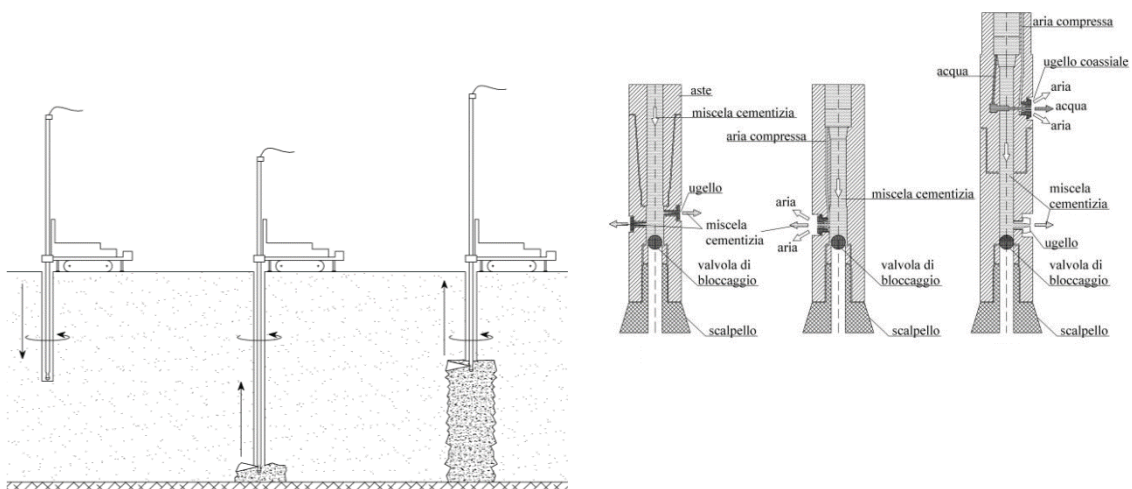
Schema tipologico del trattamento con Jet Grouting e sonde strumentate
